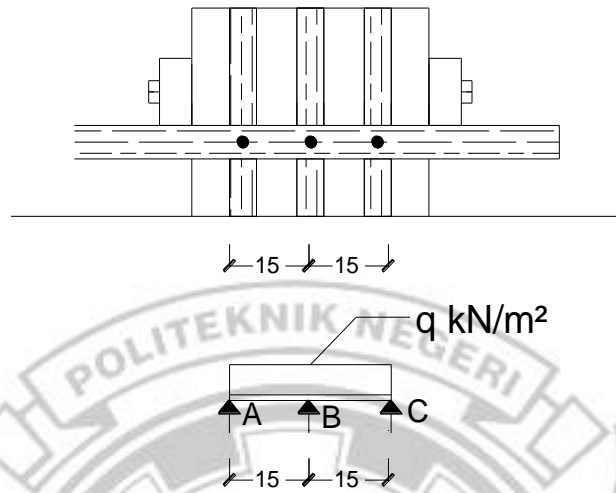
Pemodelan statik pada bekisting balok tipe balok melintang
